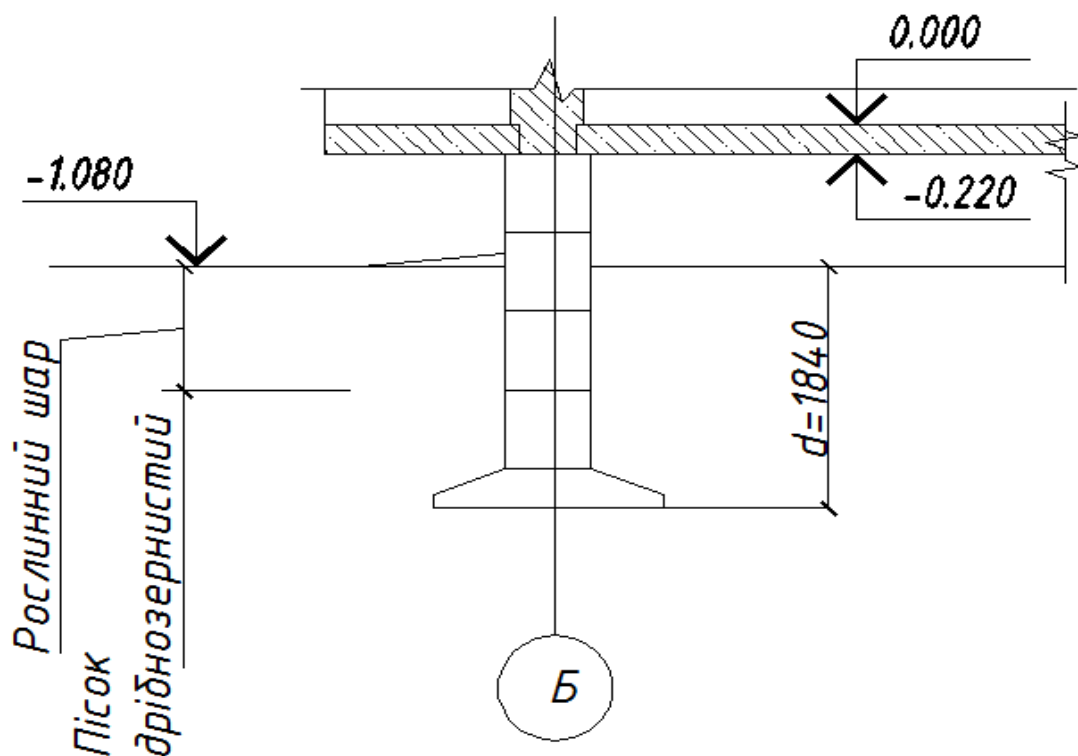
Схема розміщення фундаменту у ґрунті.
